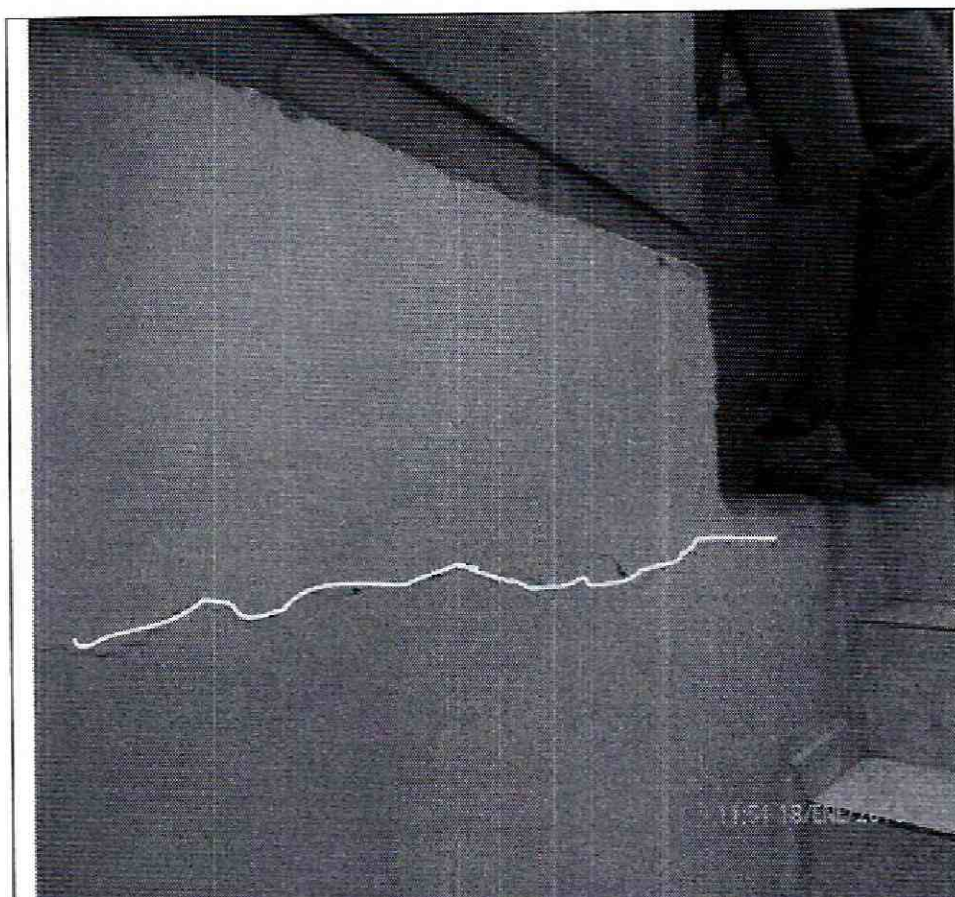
Fisura longitudinal del muro que da el acceso a la terraza.
